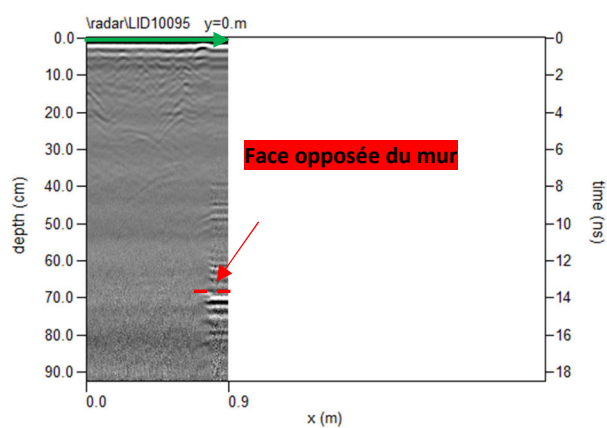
coupe radar d'un profil horizontal réalisé au niveau du mur
